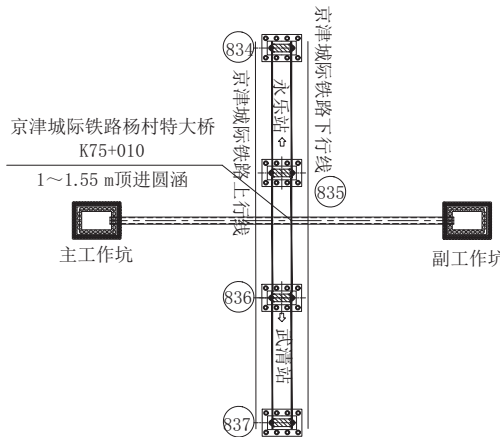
京津城际铁路杨村特大桥与钢筋混凝土顶管平面位置关系图
